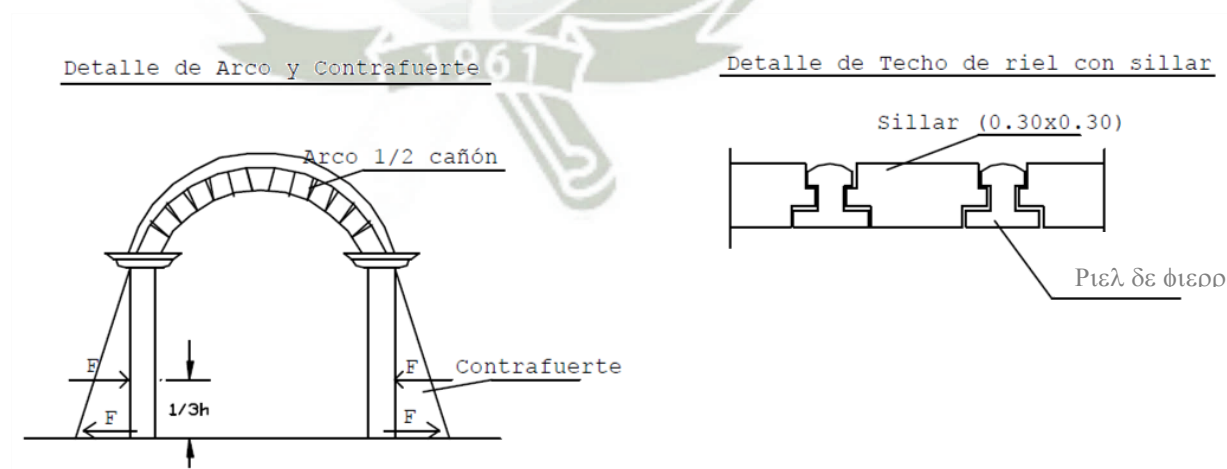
Detalles de arcos con contrafuertes y losas planas con vigas de riel
